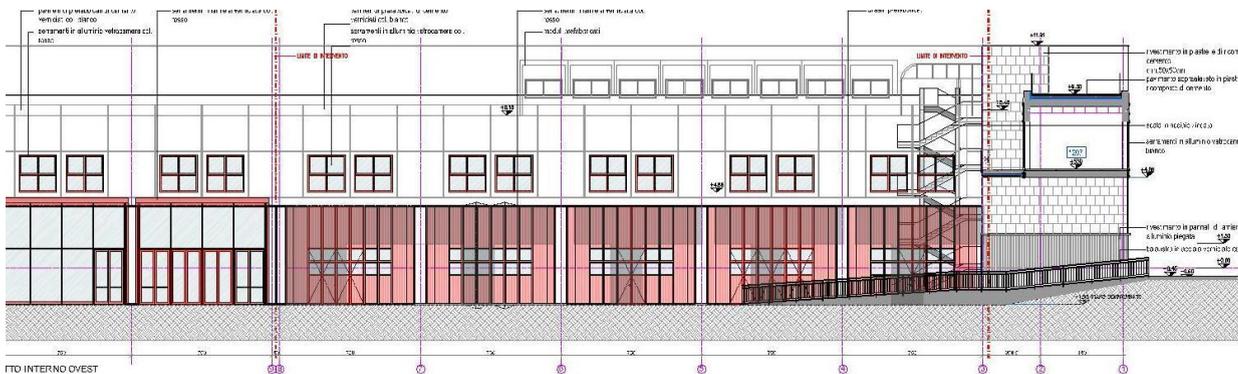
Stato di fatto – Prospetto Ovest sul cortile interno
